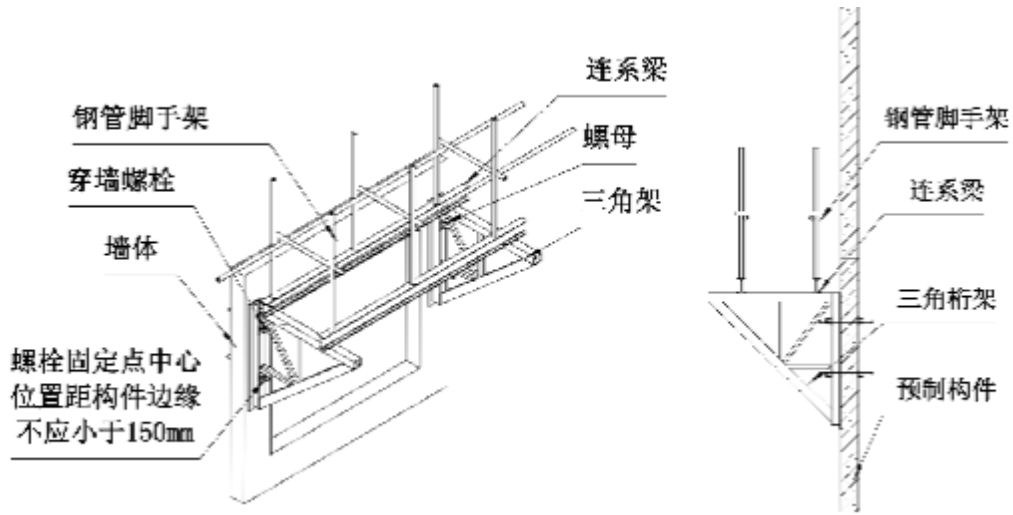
用于多层的三角桁架式防护脚手架示意图
